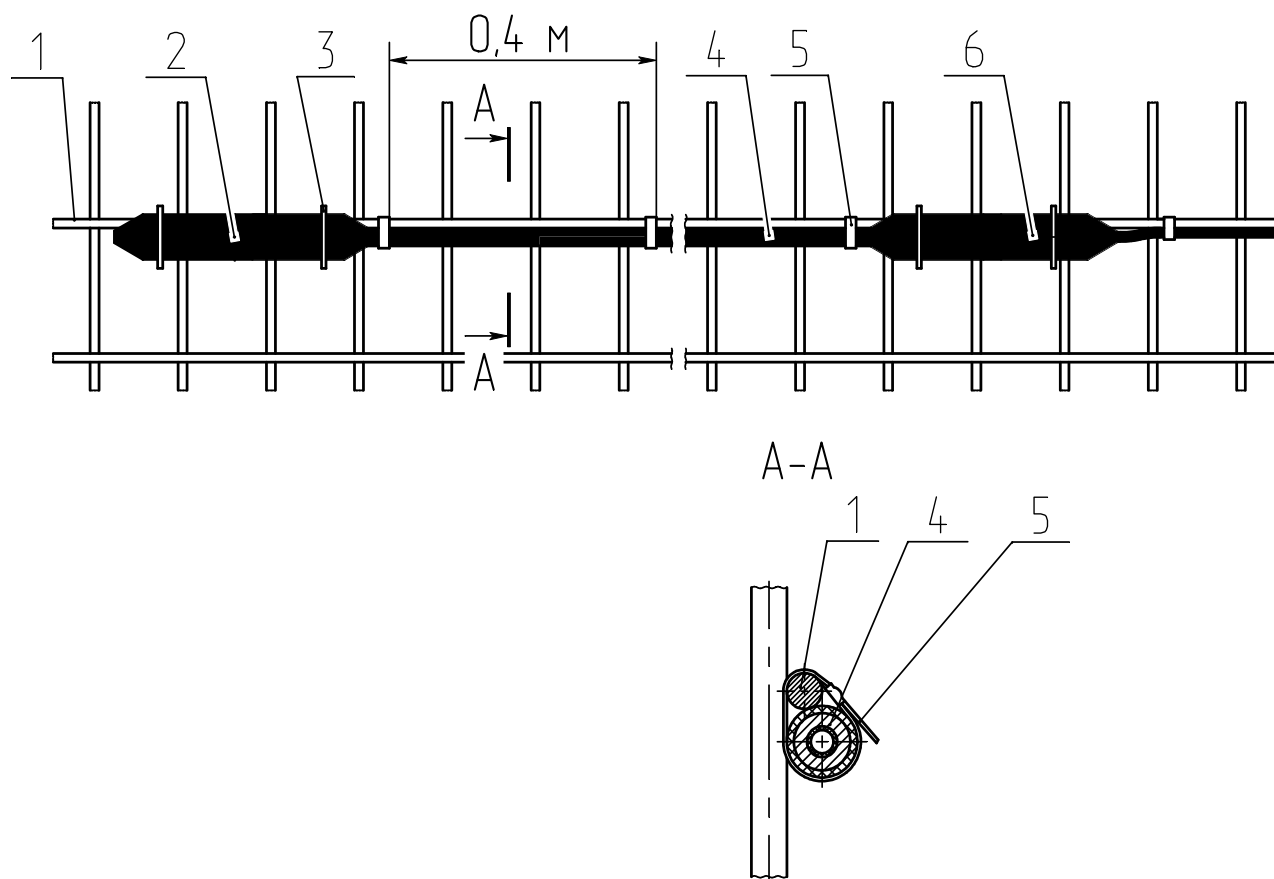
Установка ВЧЭ БАЗЖ.468239.013 (БАЗЖ.468239.013-01, БАЗЖ.468239.013-02)
